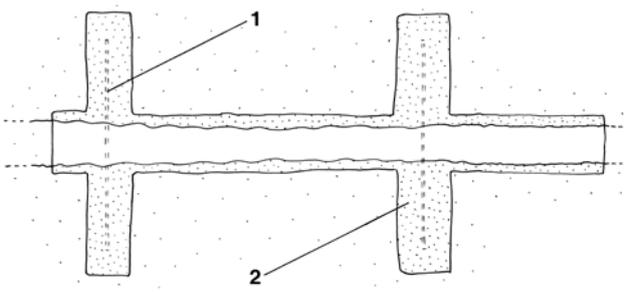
Damm aus zwei Platten, Grundriss; 1: Position des oberen Dammes; 2: Position des unteren Dammes
